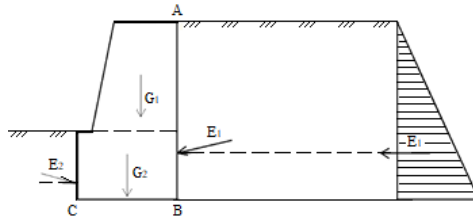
Расчетная схема к определению устойчивости подпорных стен
